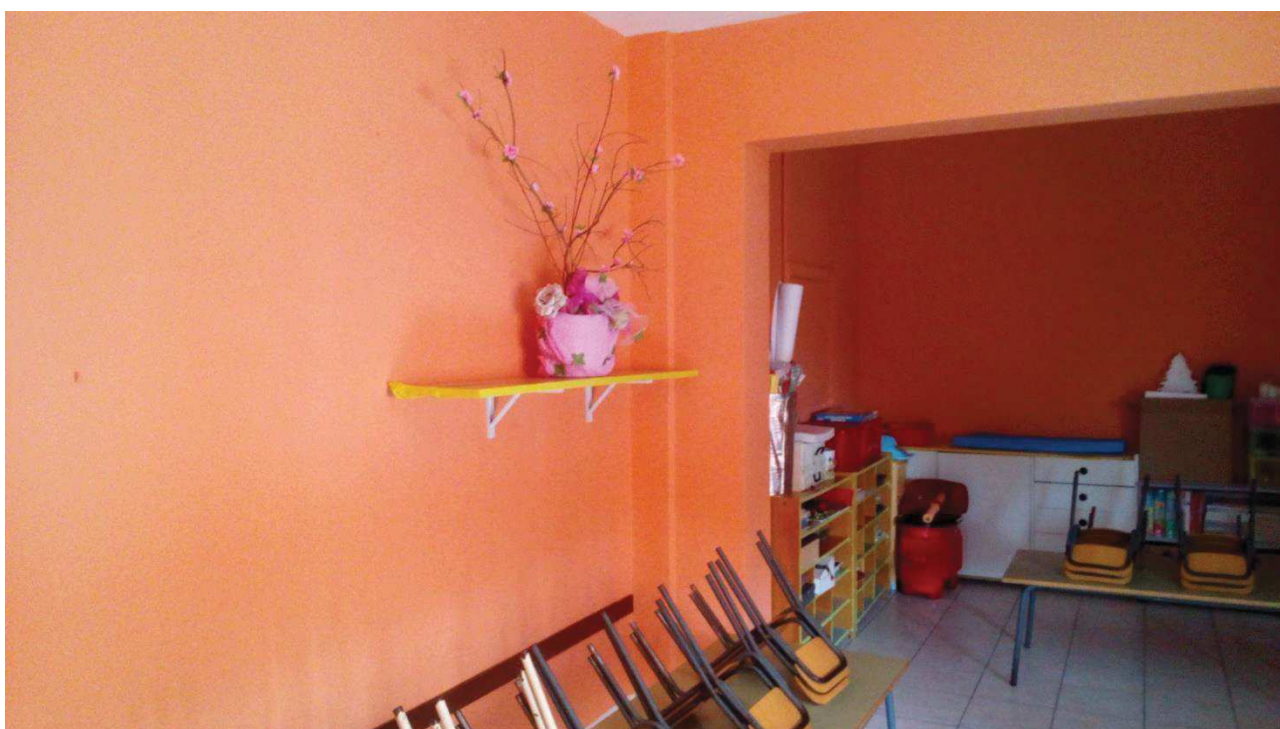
[Plesso San Pietro] Situazione delle aule interne post operam.
